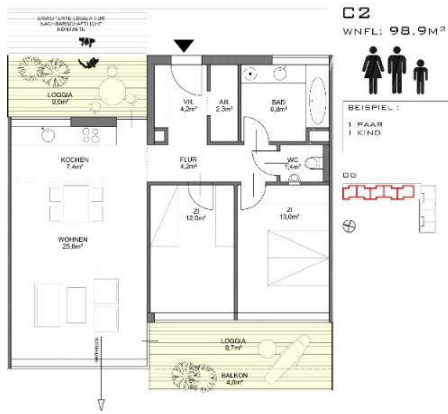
+16 Mühlgrundgasse Adaptierung der Wohnungen
